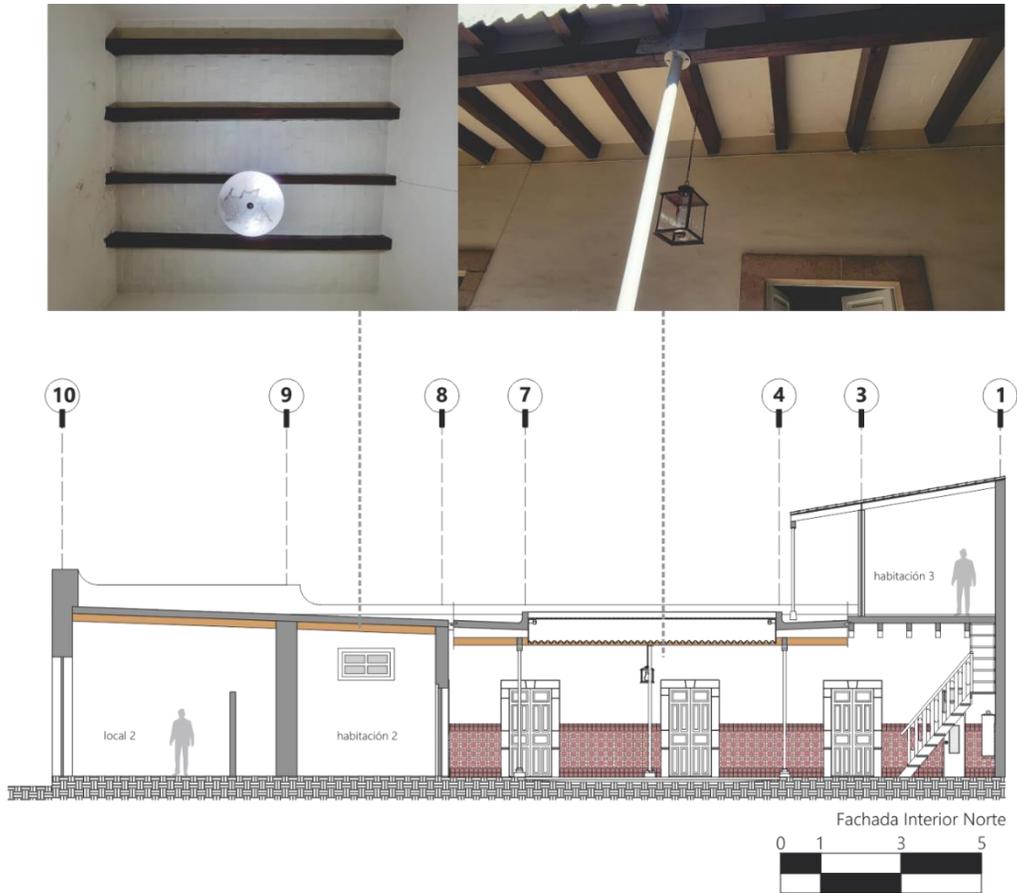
Sección longitudinal donde se muestra fachada interior norte y cubiertas. Fotografías y elaboración por KNV.
